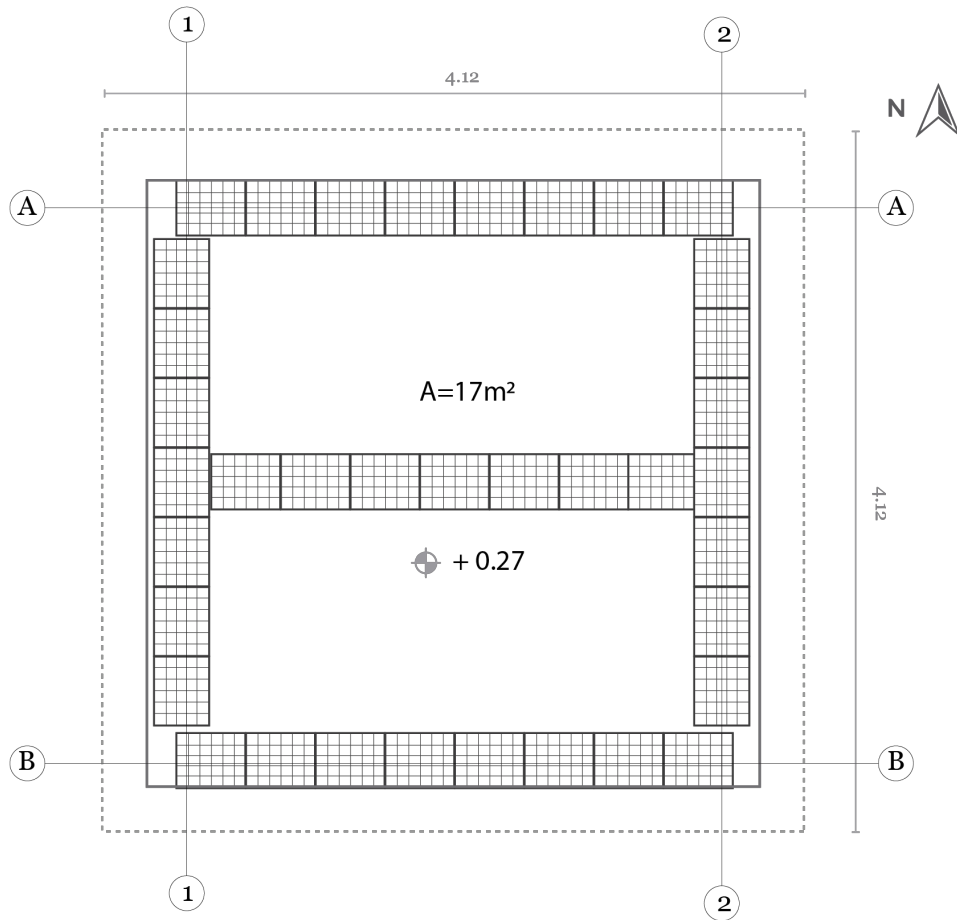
Planta Cimentación Paper Log House. Elaboración: Autores. Escala 1:50
